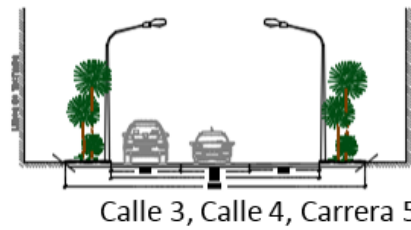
Perfil vial propuesto. Local. Fuente: Flores y otros. (2018)
